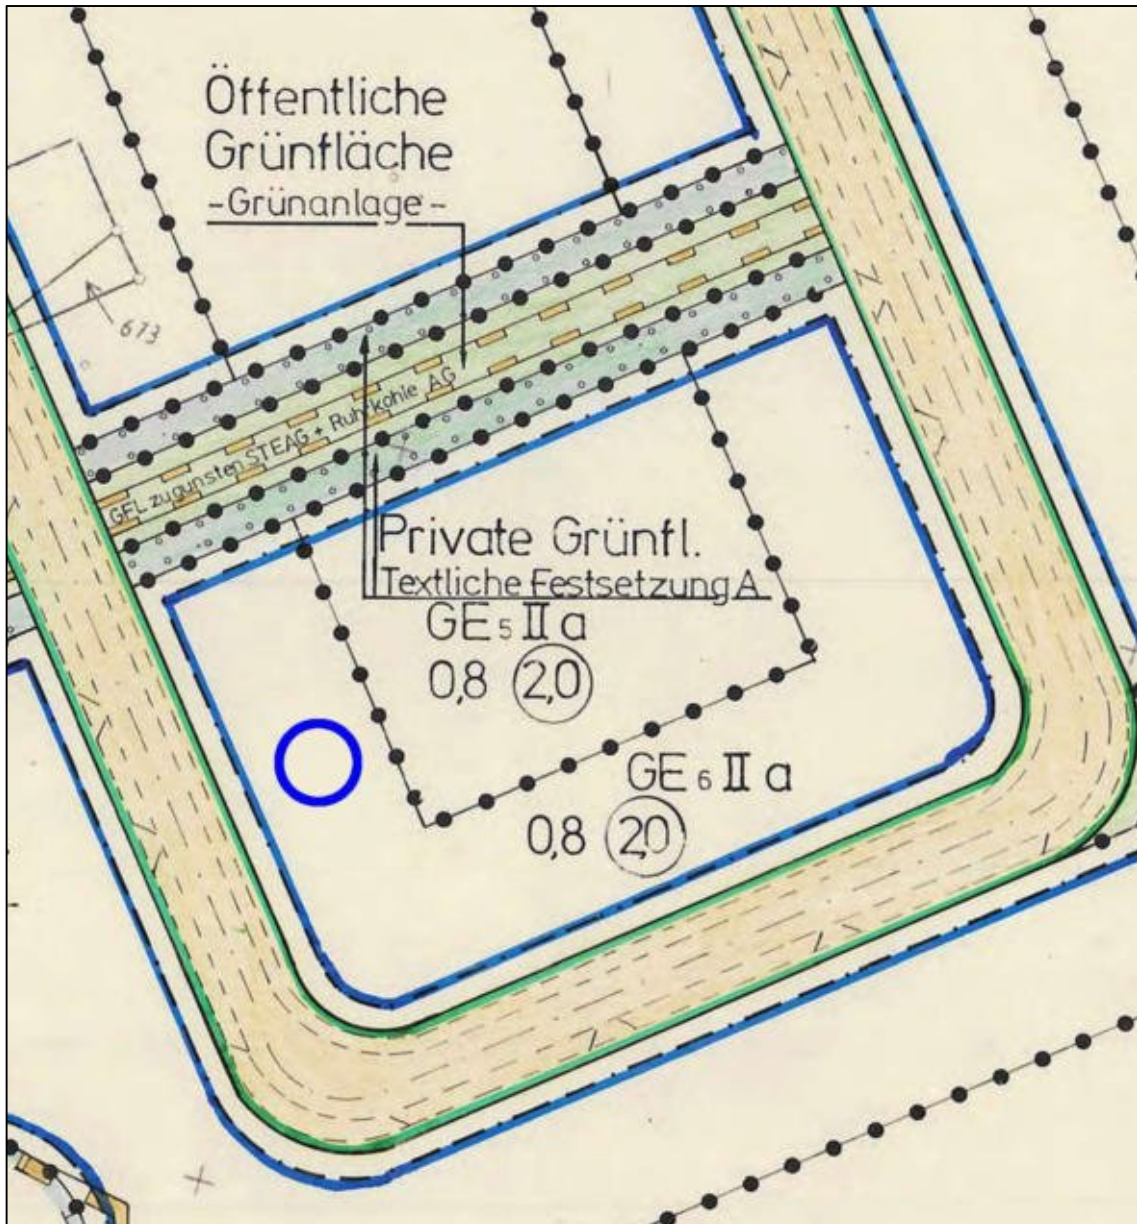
Bebauungsplan Nr. 06.062 Zeche Radbod der Stadt Hamm
